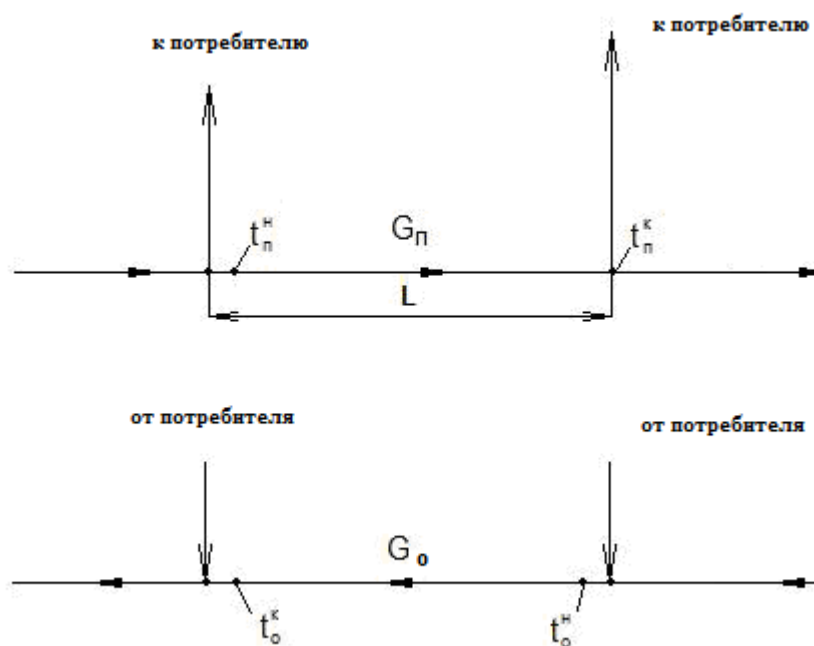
Схема тепловых испытаний участка тепловой сети
